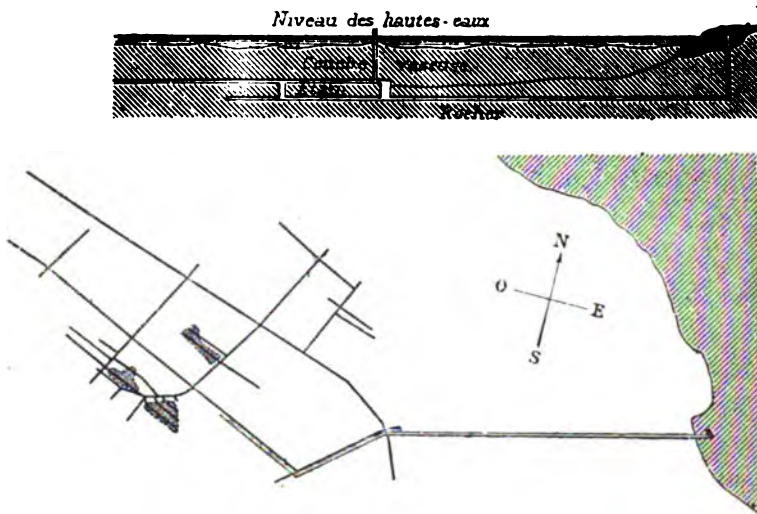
et 572. Mine d'étain sous-marine, baie de Restronguet (plan et coupe verticale).
